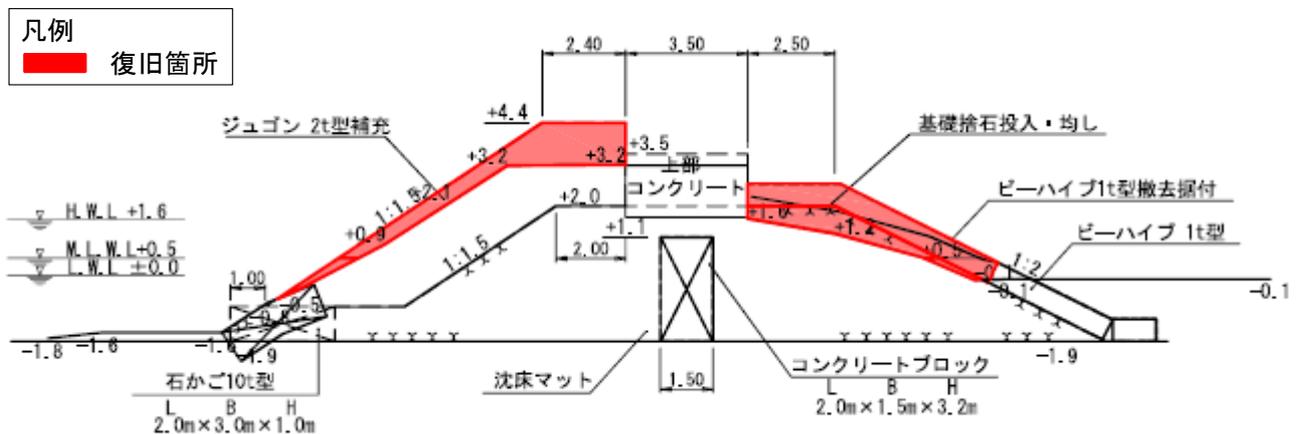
No.2 防波堤（西）の断面図 b-b'（復旧後）
